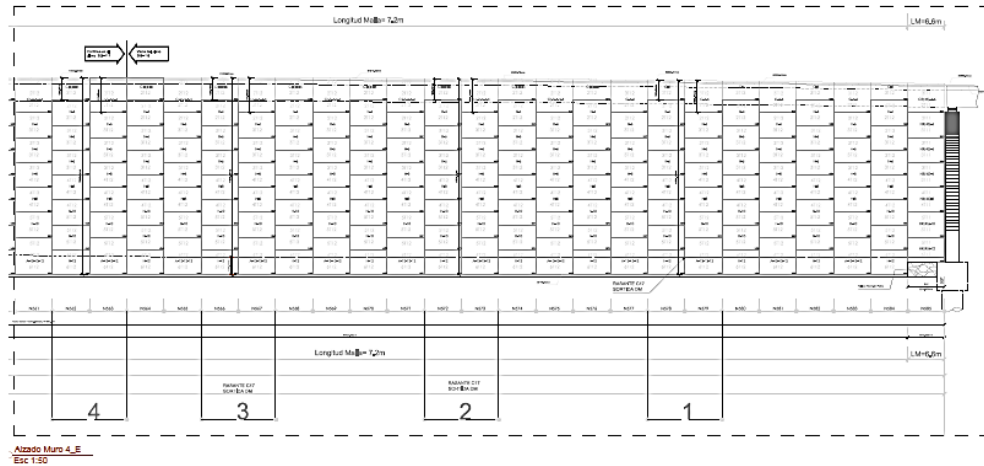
Alzado Muro 4, esquema de división de secciones a lo largo del muro.
